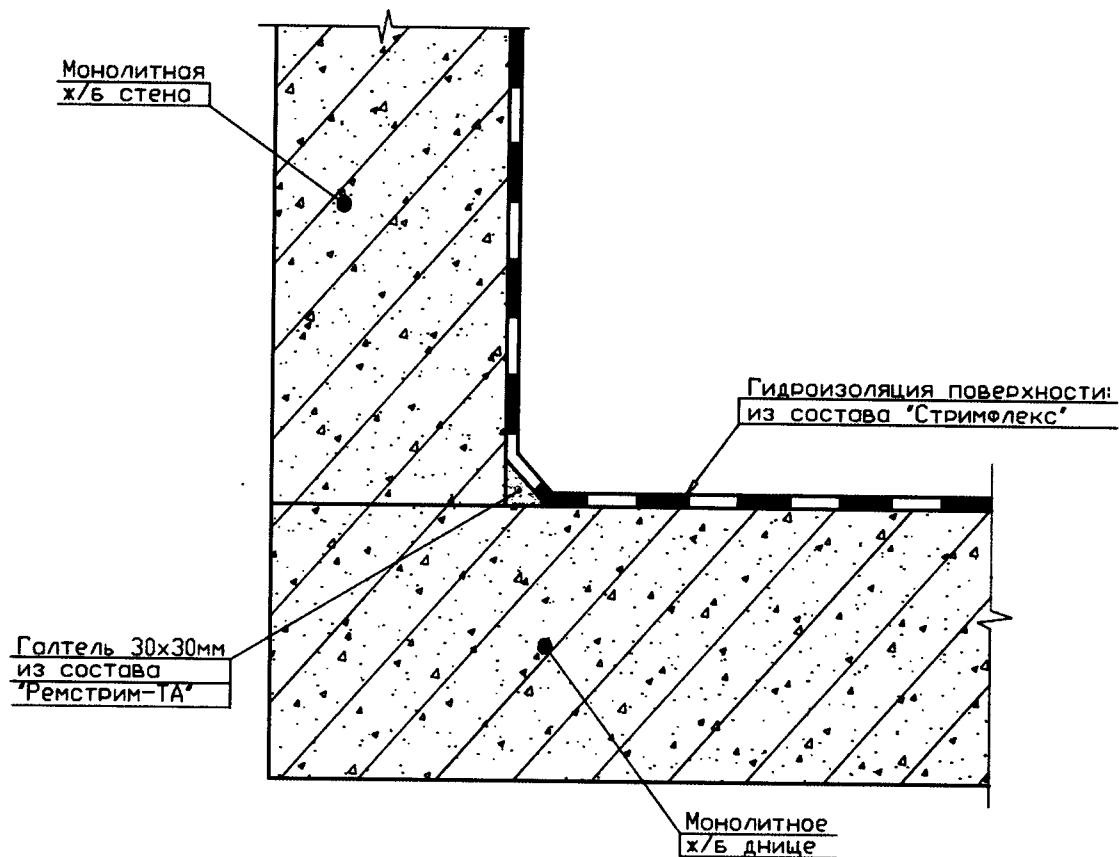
Гидроизоляция поверхностей монолитных железобетонных конструкций. Гидроизоляция поверхностей стен и днища емкостей, бассейнов
